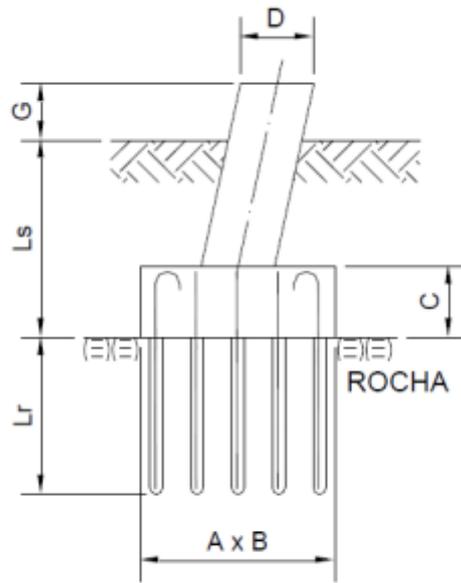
Layout* da fundação em bloco chumbado em rocha.
